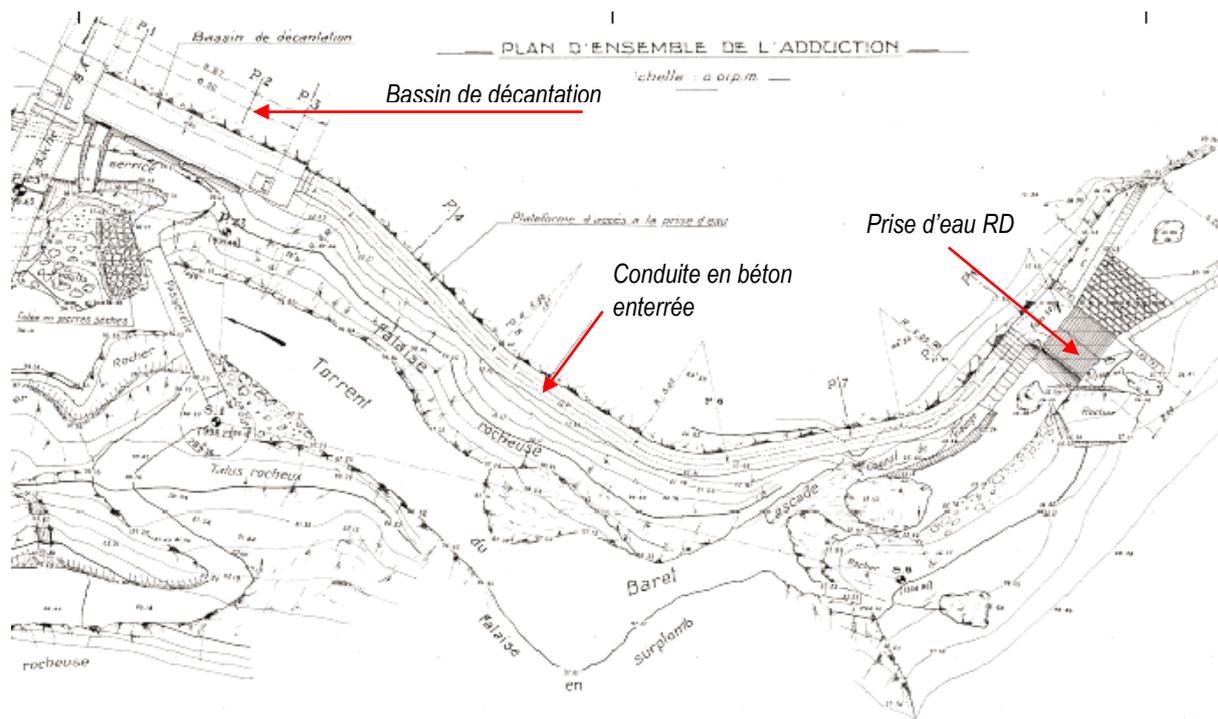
Vue en plan de la prise d'eau de Baret (torrent de la Sourde)
